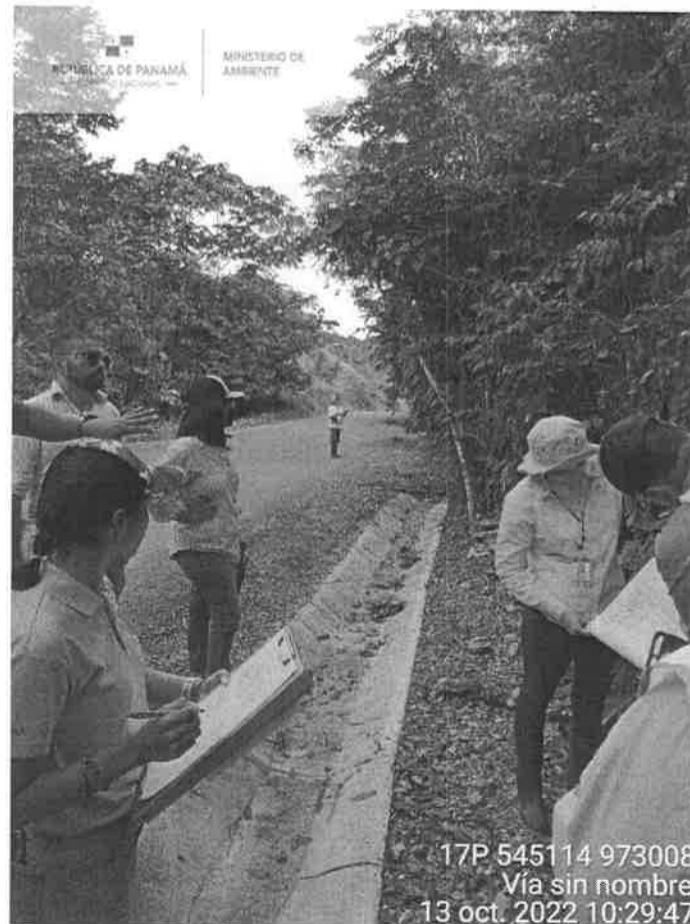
Explicación por parte del consultor sobre el proyecto.
